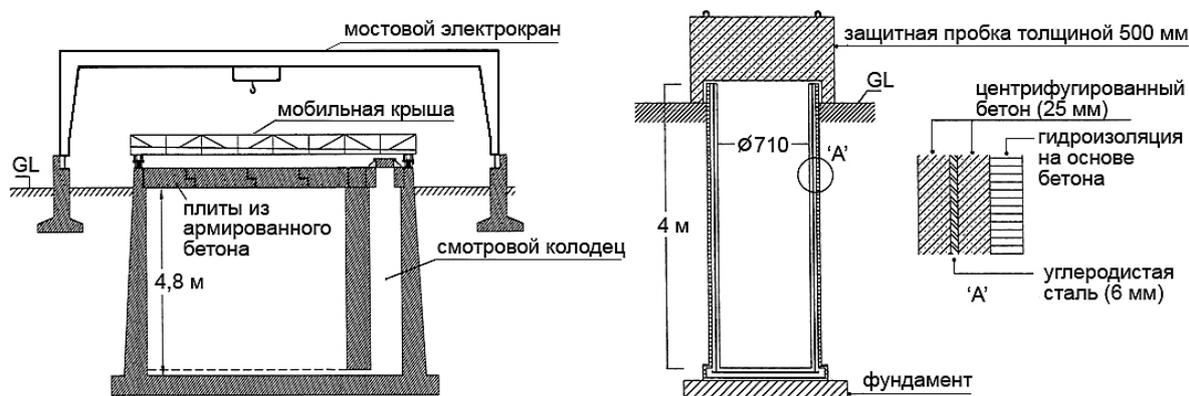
Конструкция траншеи с облицовкой из армированного бетона (слева) и скважины, облицованные керамическими плитами (справа)
